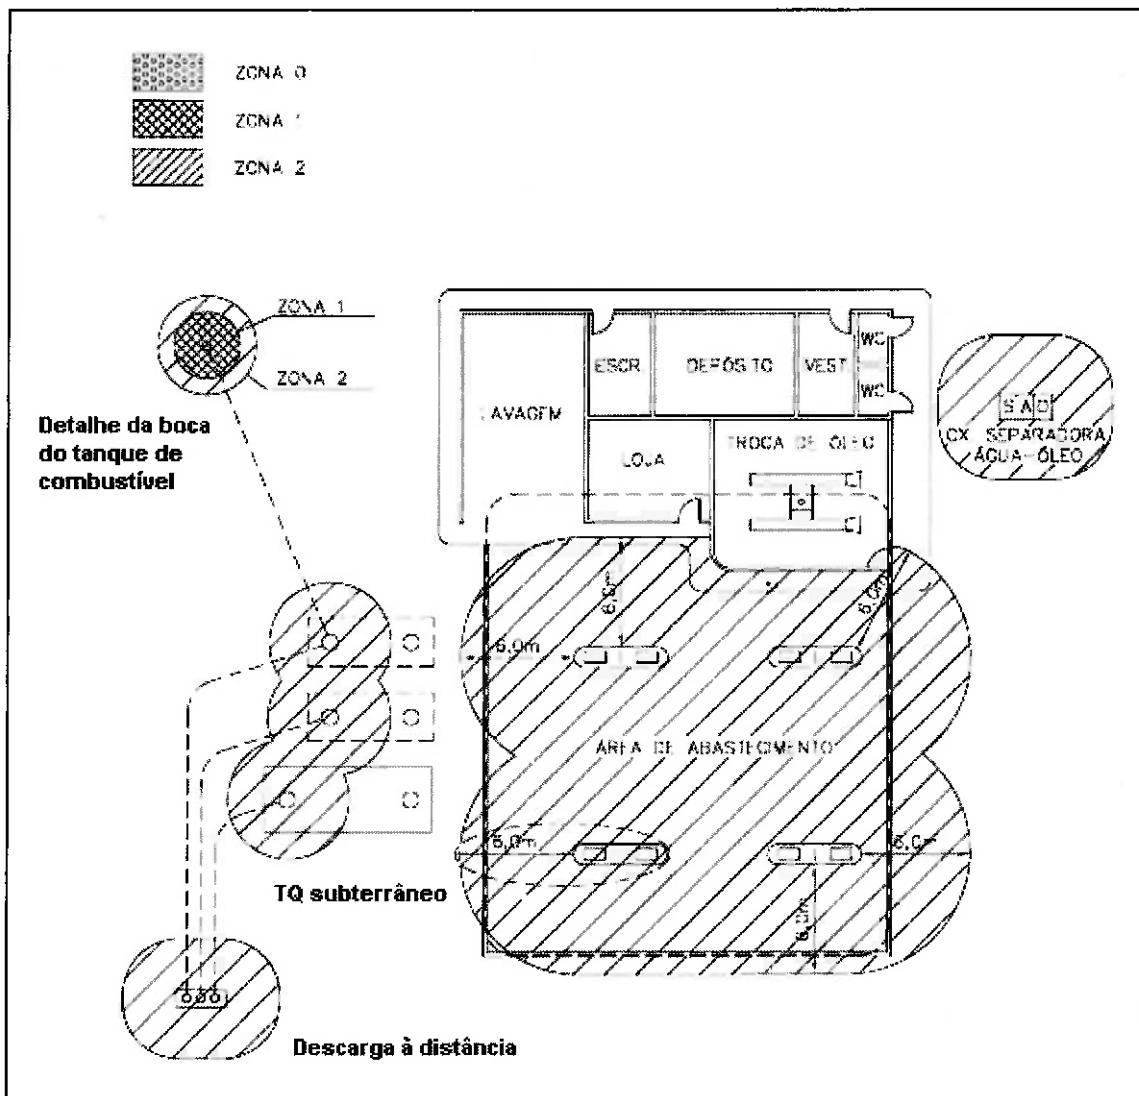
Planta de um modelo de posto de serviço - adaptado
